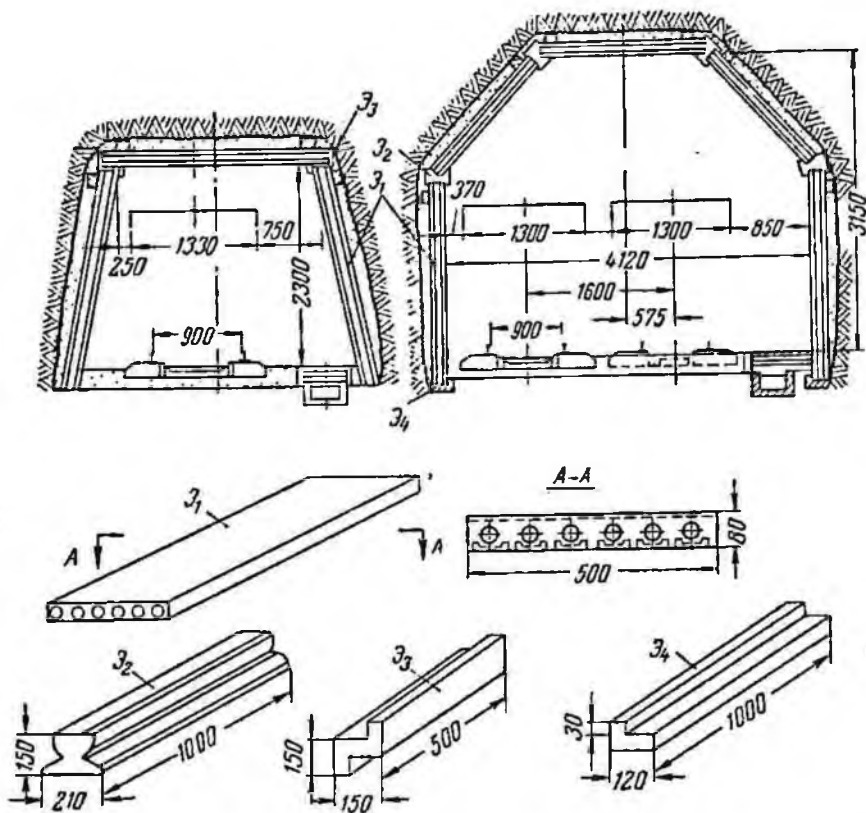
Сборная железобетонная крепь из напряженно армированных плит (НАП)
